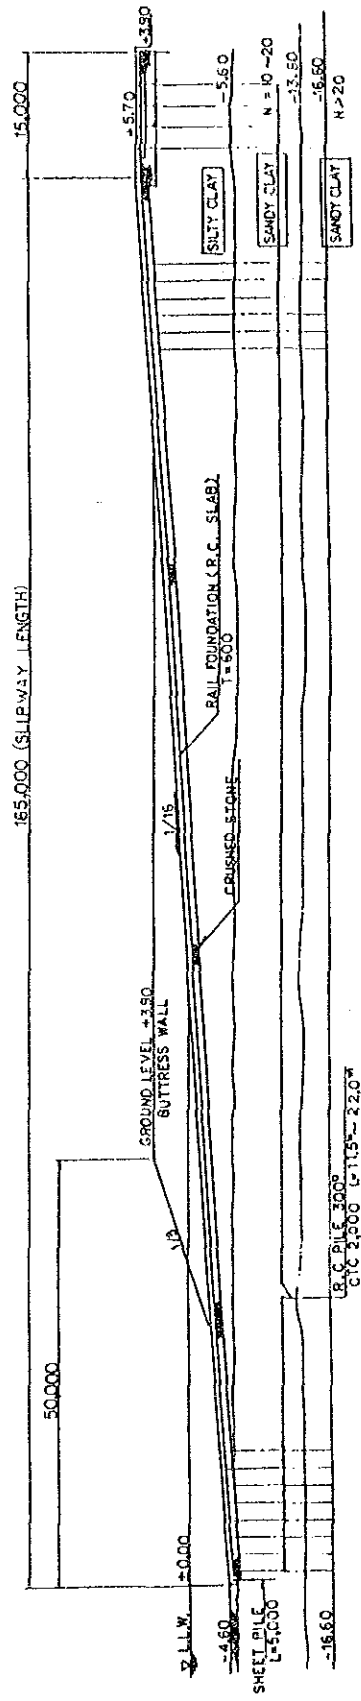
(1 / 3) スリップウェイ平面図及び縦断面図 (Bandon)
